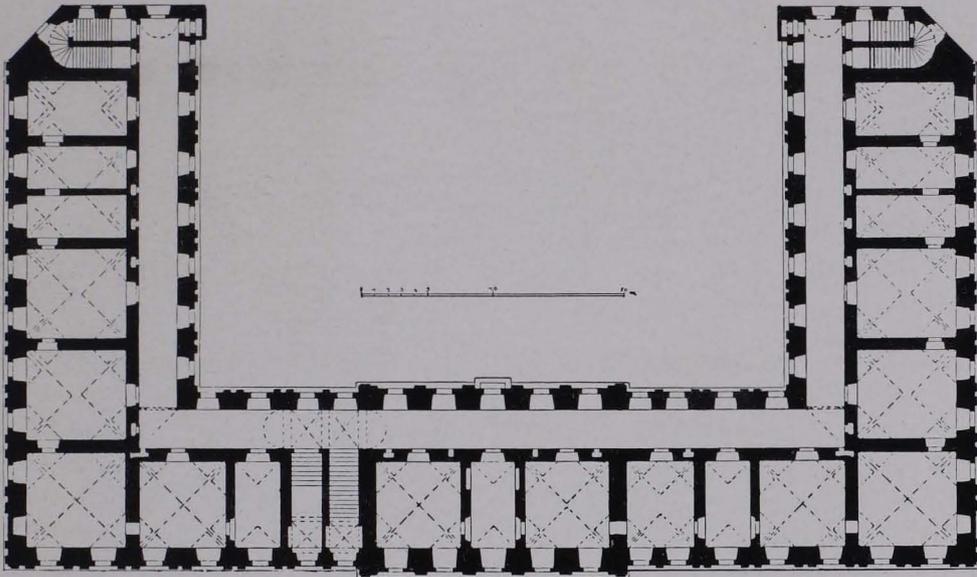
Pläß, Prälaten. Grundriß, Erdgeschoß *Rekonstruktion gemeinsam mit Arch. S. Bauer
